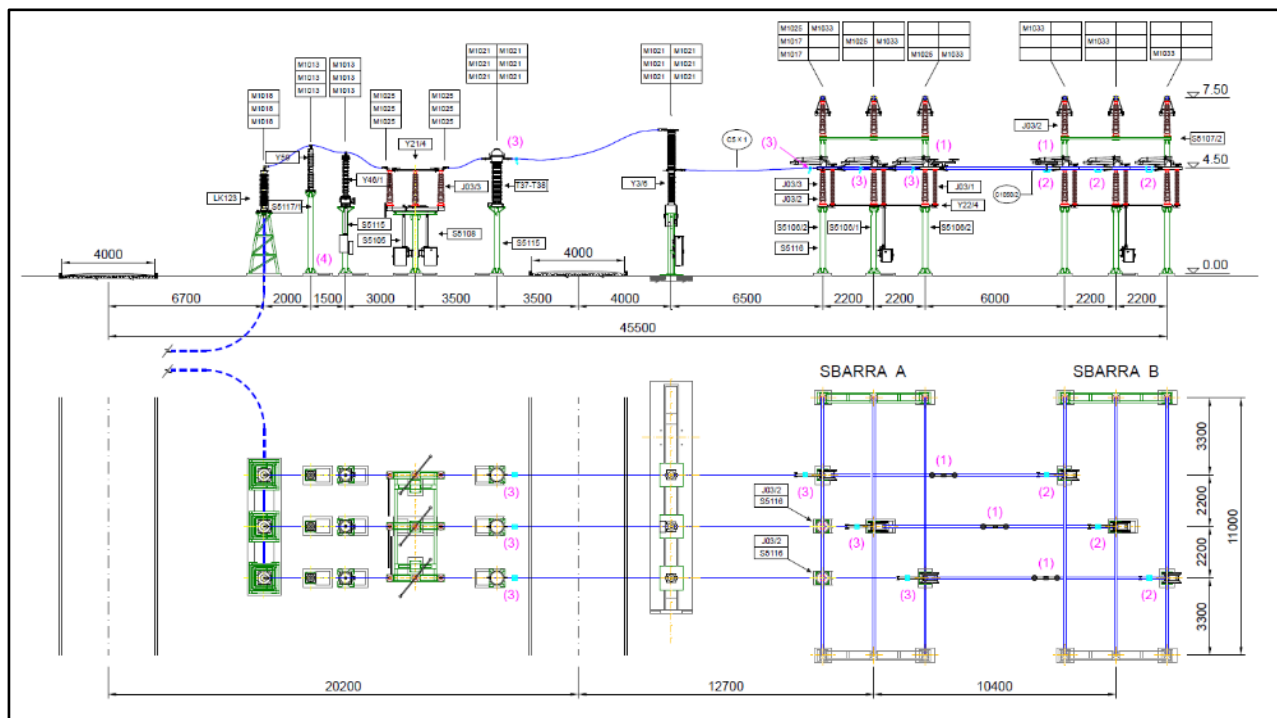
Planimetria e sezione elettromeccanica relativa alle apparecchiature dello stallo 150 kV nella stazione Terna
